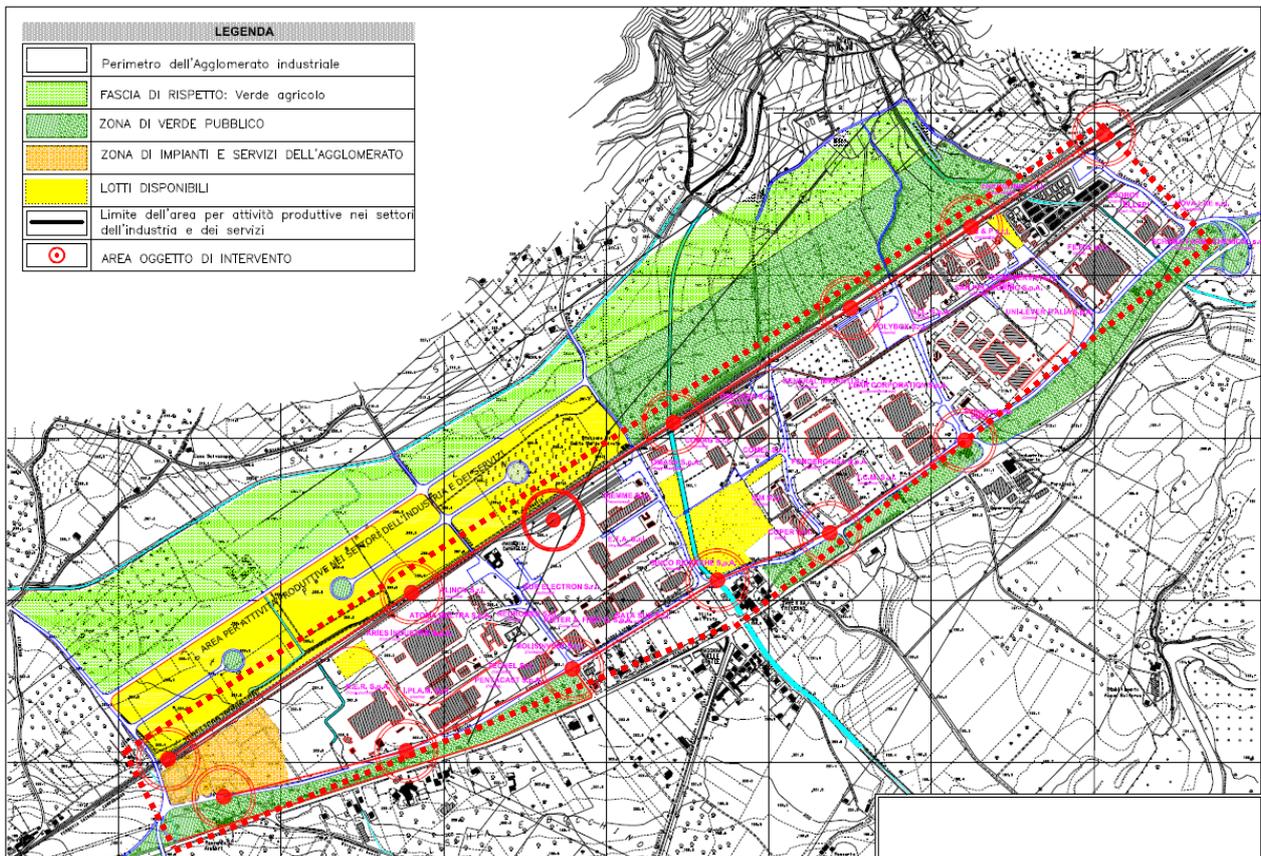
vista aerea dettaglio zona intervento e stralcio C.T.R..
